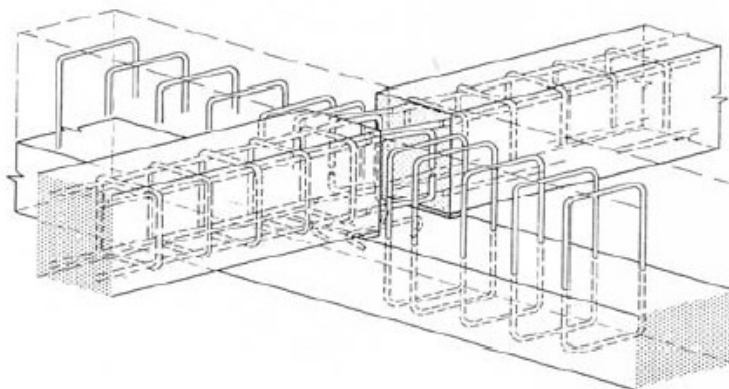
Ligação viga principal – viga secundaria através de betonagem *in situ* do nó (STUPRÉ, 1981).
